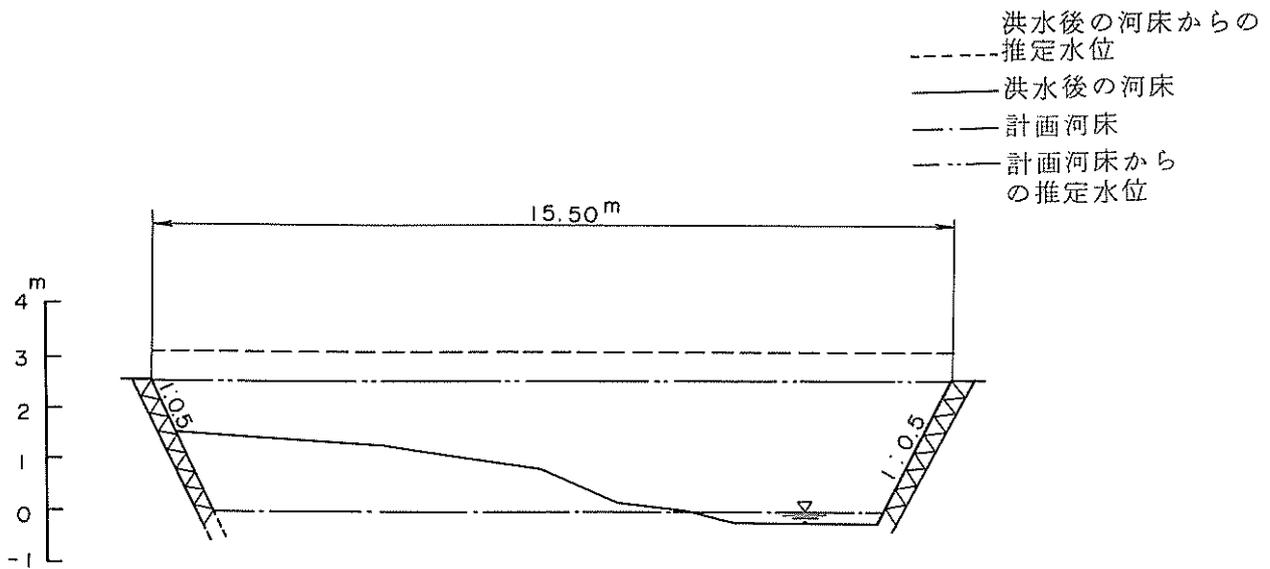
横断面図 (A地点) (島根県浜田土木建築事務所調査)
